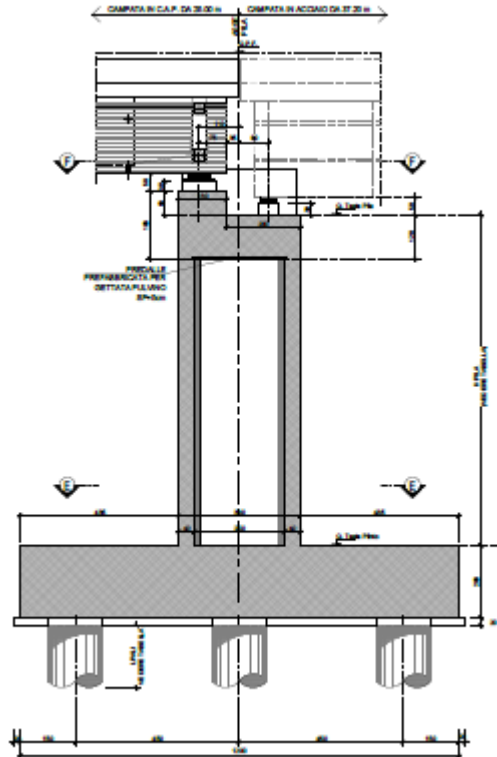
Sezione in direzione longitudinale rispetto all'asse del viadotto
